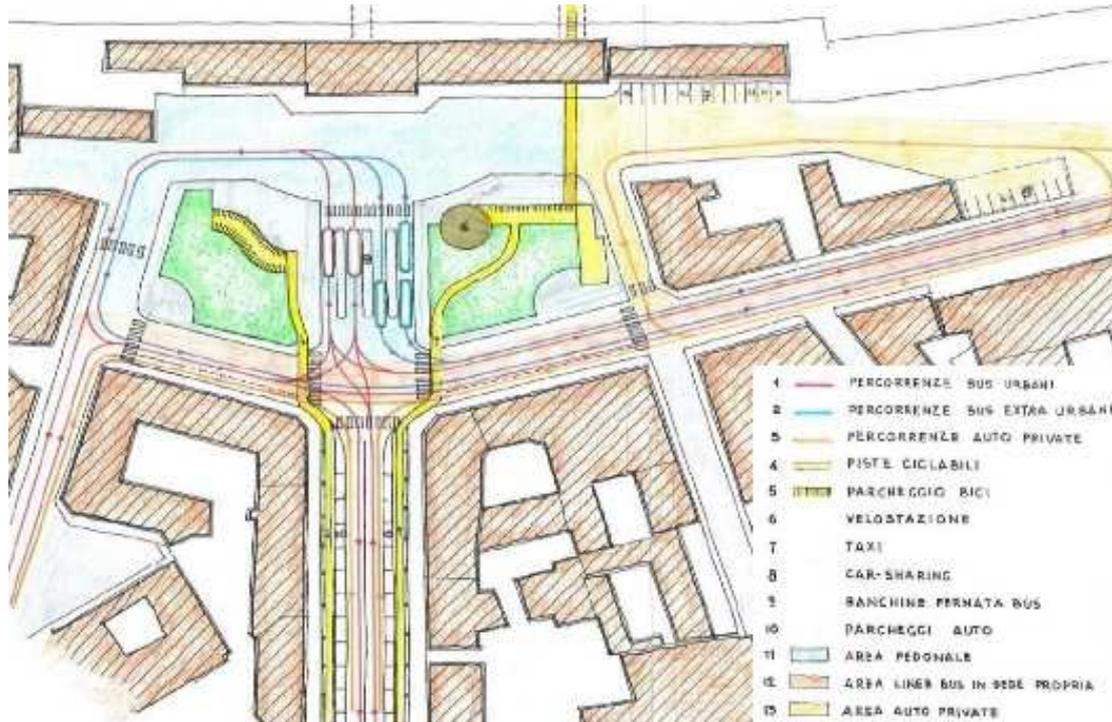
Nuovo assetto dell’asse di via Vittorio Emanuele II e della piazza della stazione³
